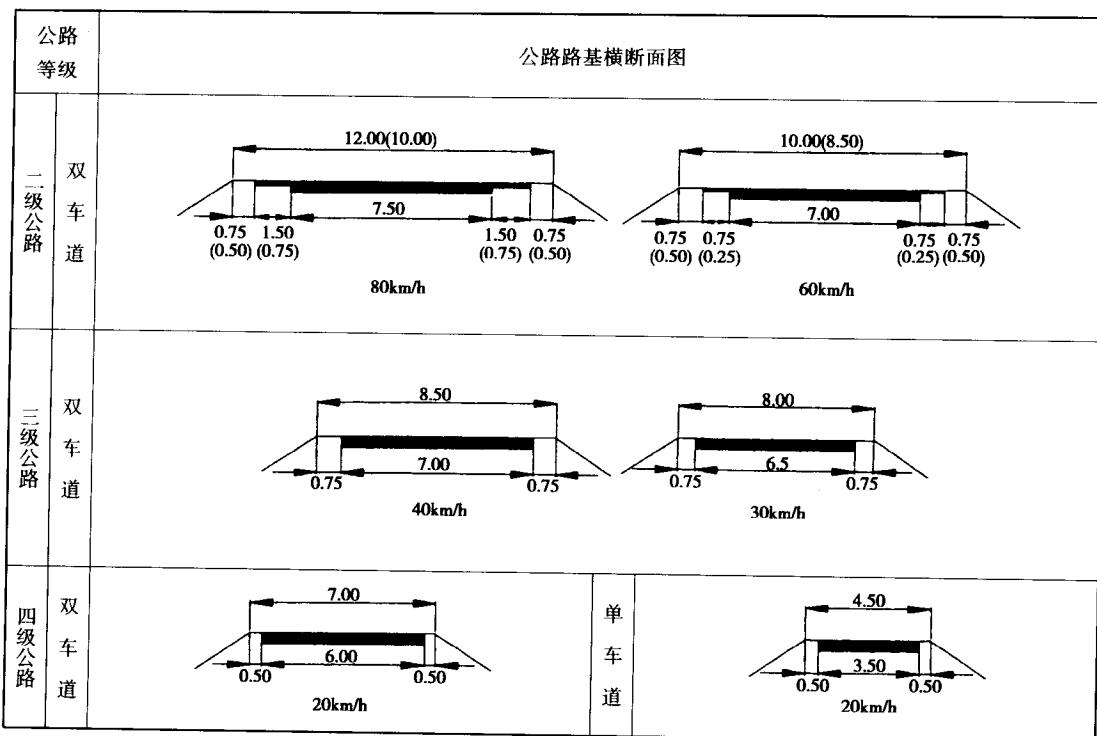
县乡公路路基横断面图(尺寸单位:m)
